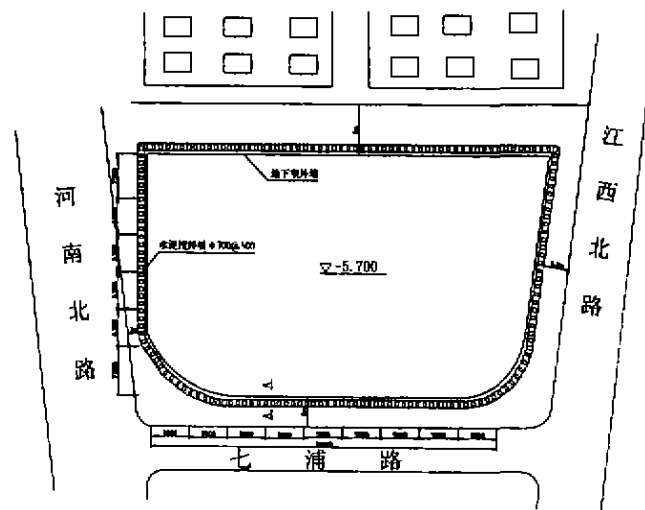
上海市七浦路服饰商场工程地下室基坑围护结构平面布置图
